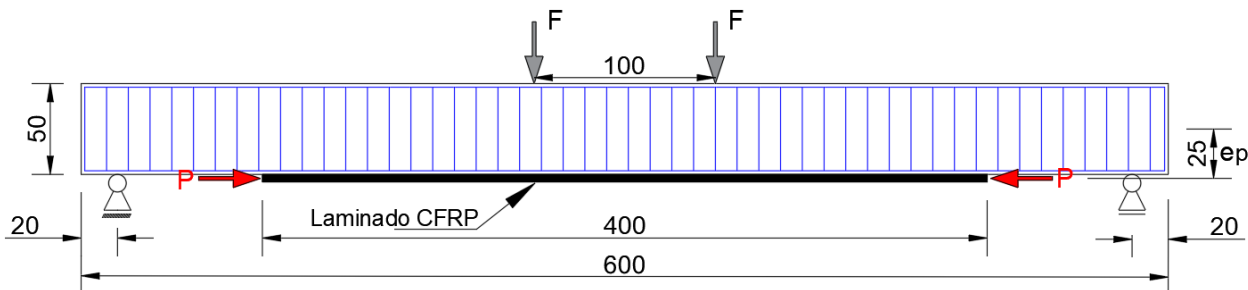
Configuração de ensaio e reforço das vigas. Dimensões em cm.
